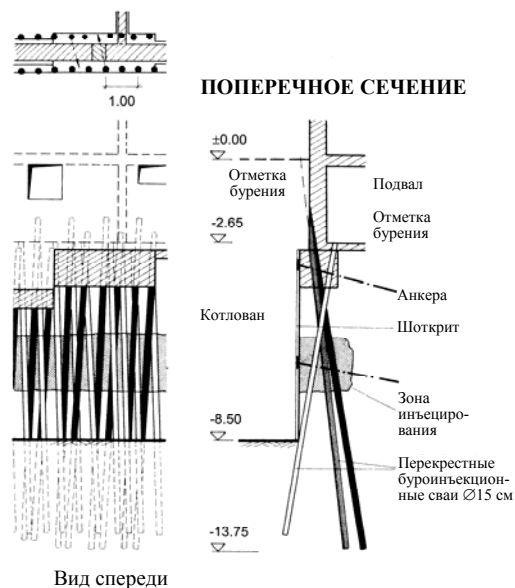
Укрепление фундамента с помощью коневидных свай, локальное цементирование и предварительно-напряженные анкера для откопки котлована
